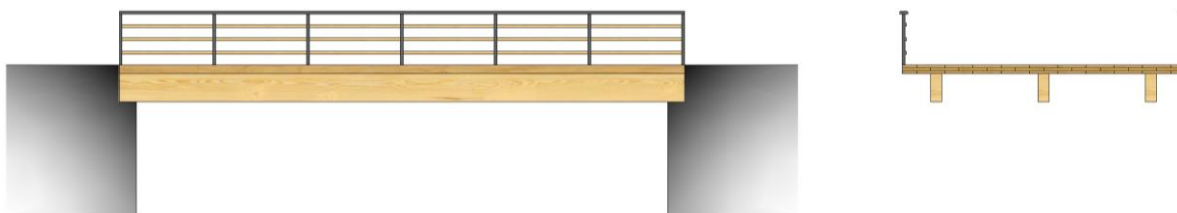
Estrutura composta por vigas simplesmente apoiadas.
